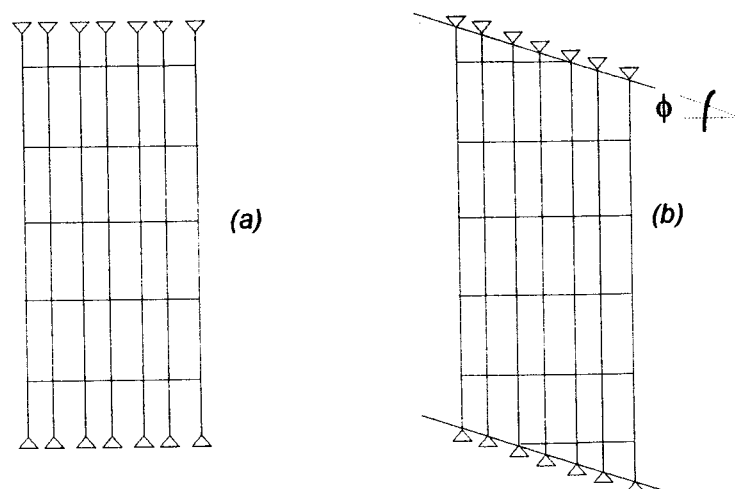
Grelhas Ortogonais : (a) Planta ortogonal.
